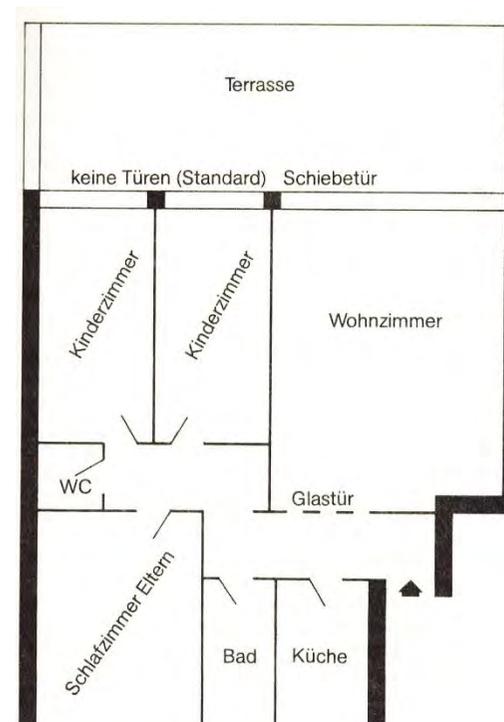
, Grundriss eines standard Wohnung[6]
